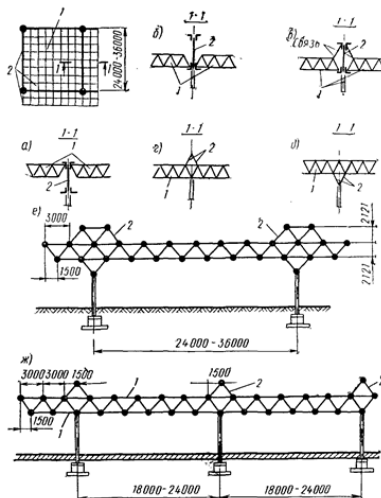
Варианты опирания перекрестно-стержневой пространственной конструкции (1) на подстропильные фермы (2)
